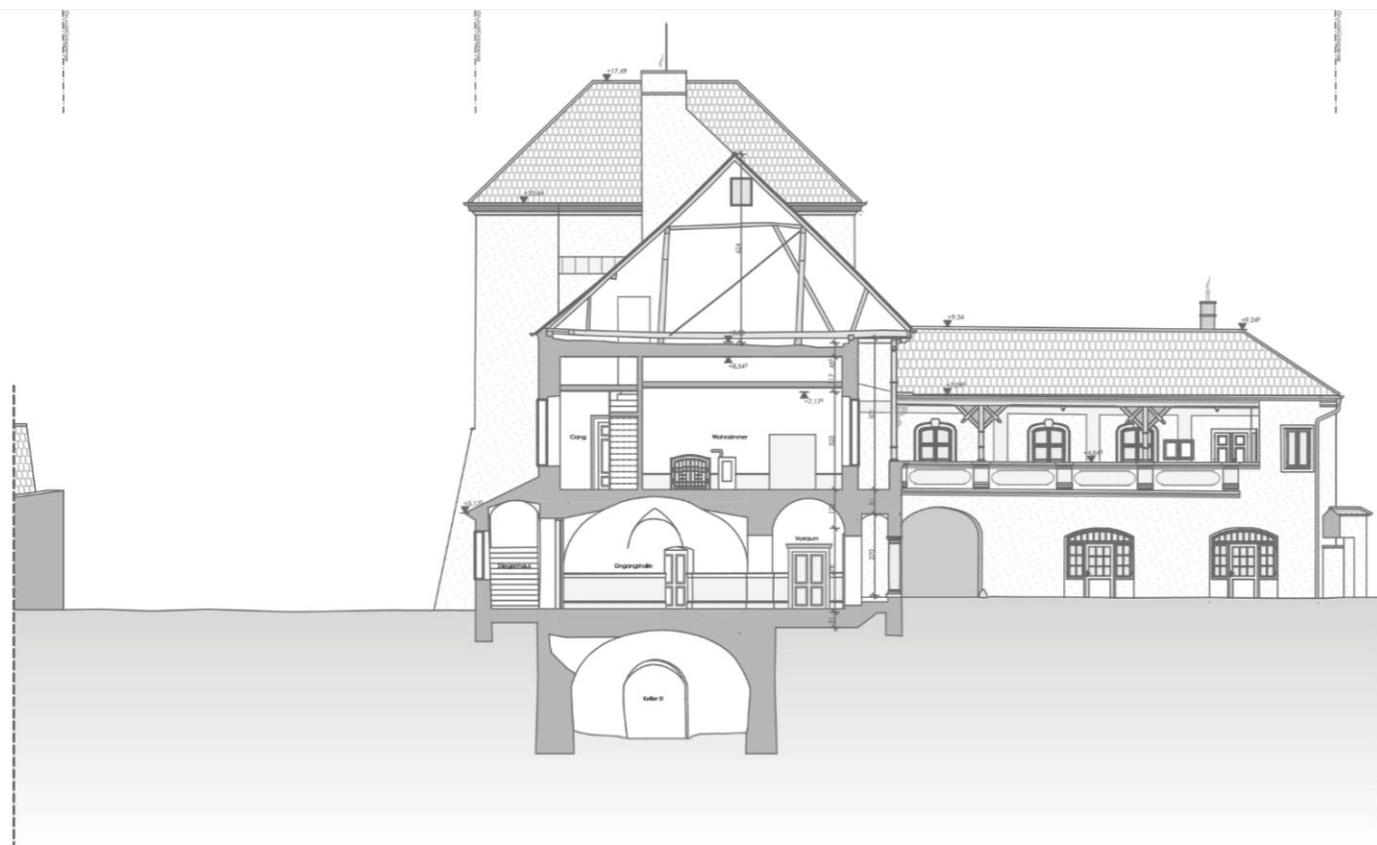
Bestandsplan Schnitt 3-3 M 1:250
